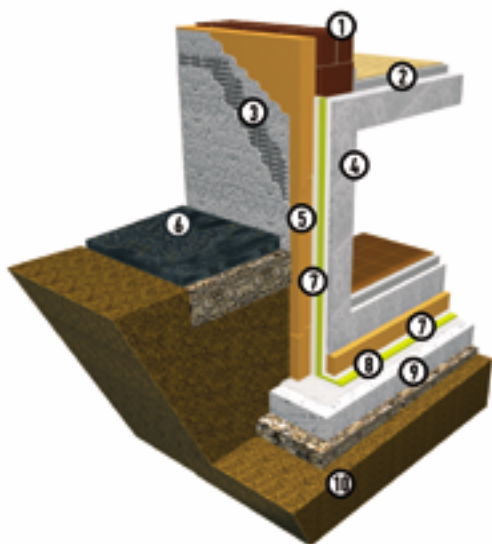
Устройство заглубленной конструкции: 1 – стена; 2 – перекрытие пола первого этажа; 3 – декоративное покрытие; 4 – стена паркинга; 5 – ПЕНОПЛЭКС®; 6 – отмостка; 7 – геотекстиль плотностью не менее 300 г/м²; 8 – PLASTFOIL®Geo; 9 – фундамент; 10 – грунт
